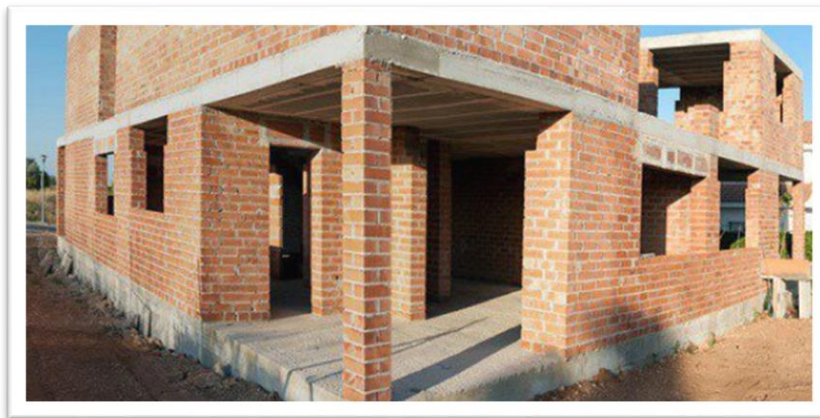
5 Mampostería confinada (Arquitectura, 2015)
